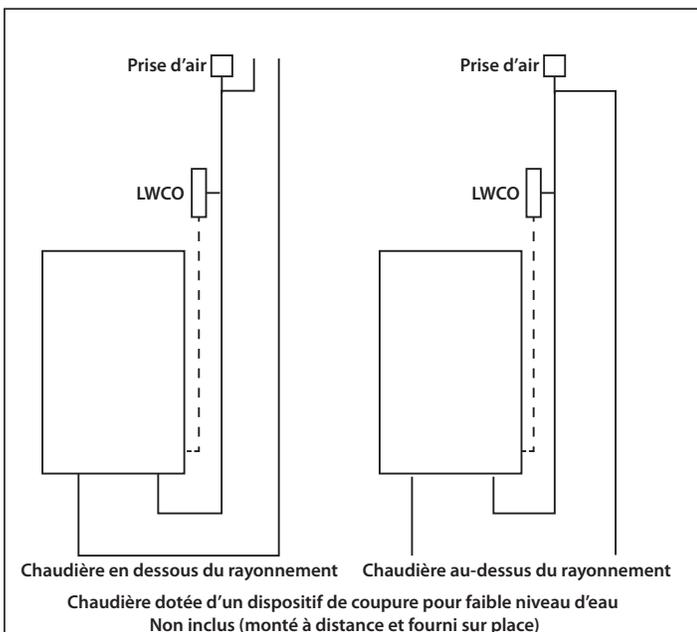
Installation de base du dispositif de coupure pour faible niveau d'eau
